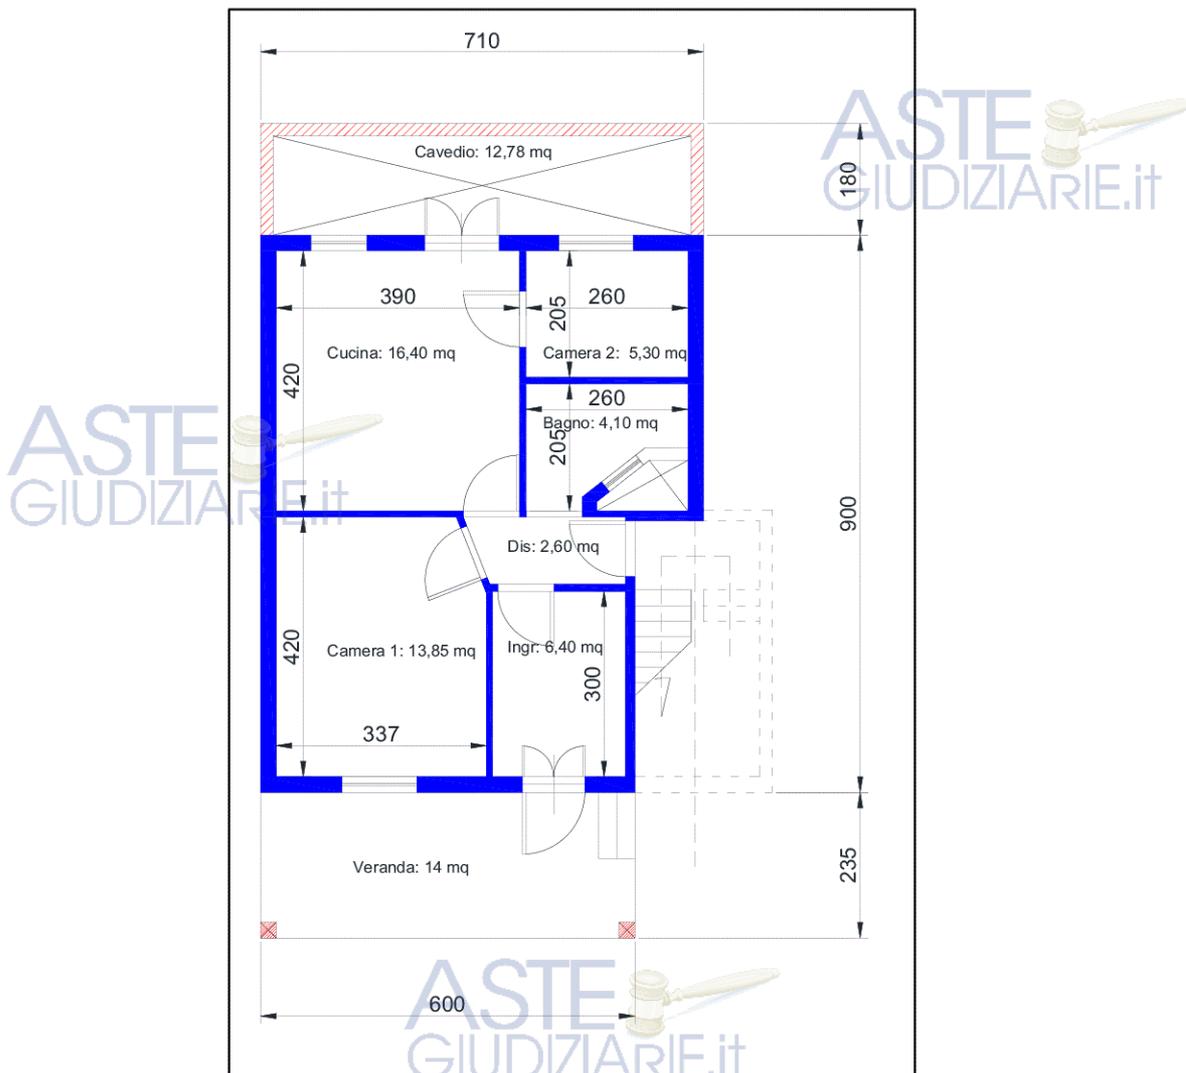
pianta immobile p.lla 432 sub 1 P.T - rilievo
